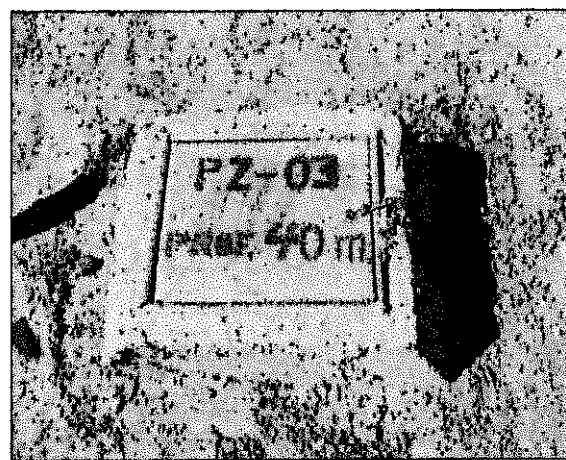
Instalación de Piezómetro PZ - 03, ubicado de la parte baja de las Pozas PLS-ILS.
